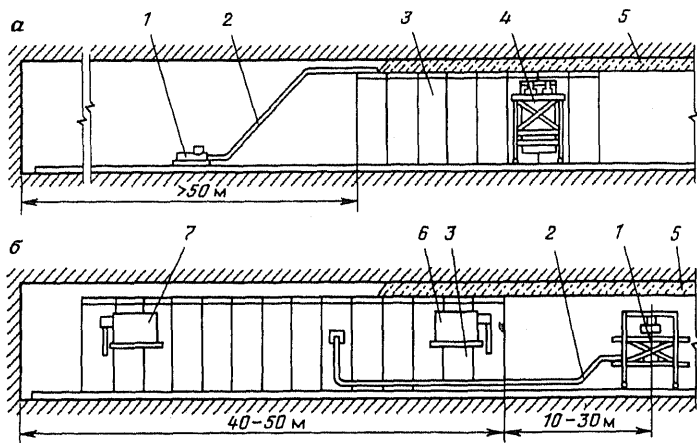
Схемы бетонирования обделки при различных положениях бетоноукладчика: *а* — перед опалубкой; *б* — позади опалубки; 1 — бетоноукладчик; 2 — бетоновод; 3 — сборно-разборная опалубка; 4 — механизм передвижения опалубки; 5 — бетонная обделка; 6 и 7 — перестановщики опалубки задний и головной
